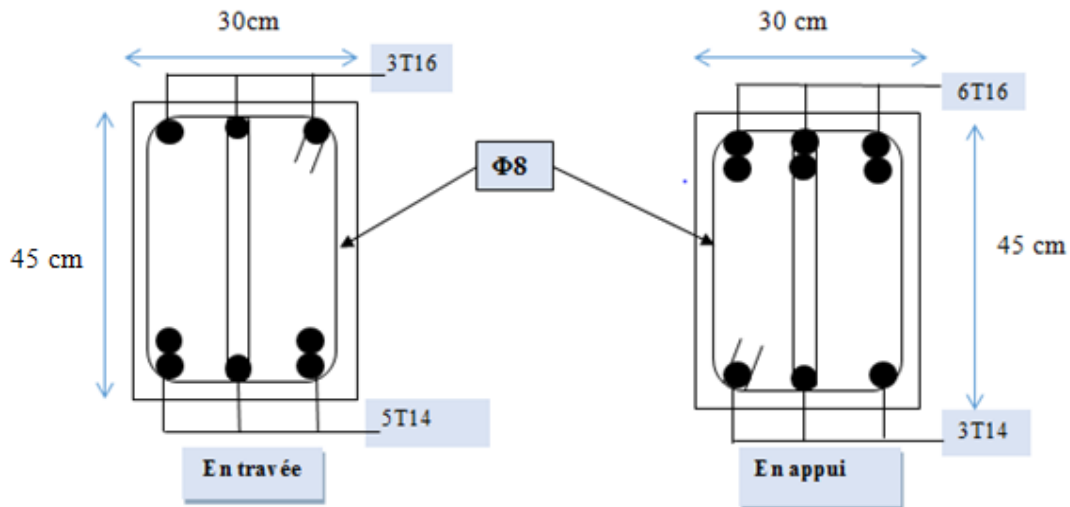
Ferrailage des poutres principales (30×45) cm^2
